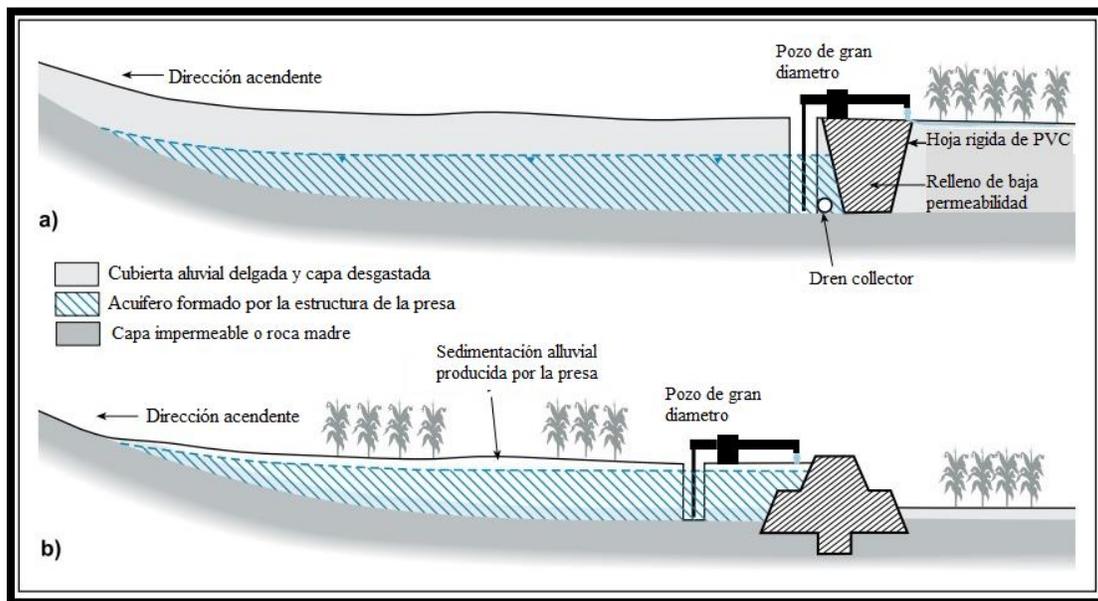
Secciones longitudinales de las estructuras de (a) presa subterránea y (b) presa de almacenamiento de arena (Foster y Tuinhof, 2004)
